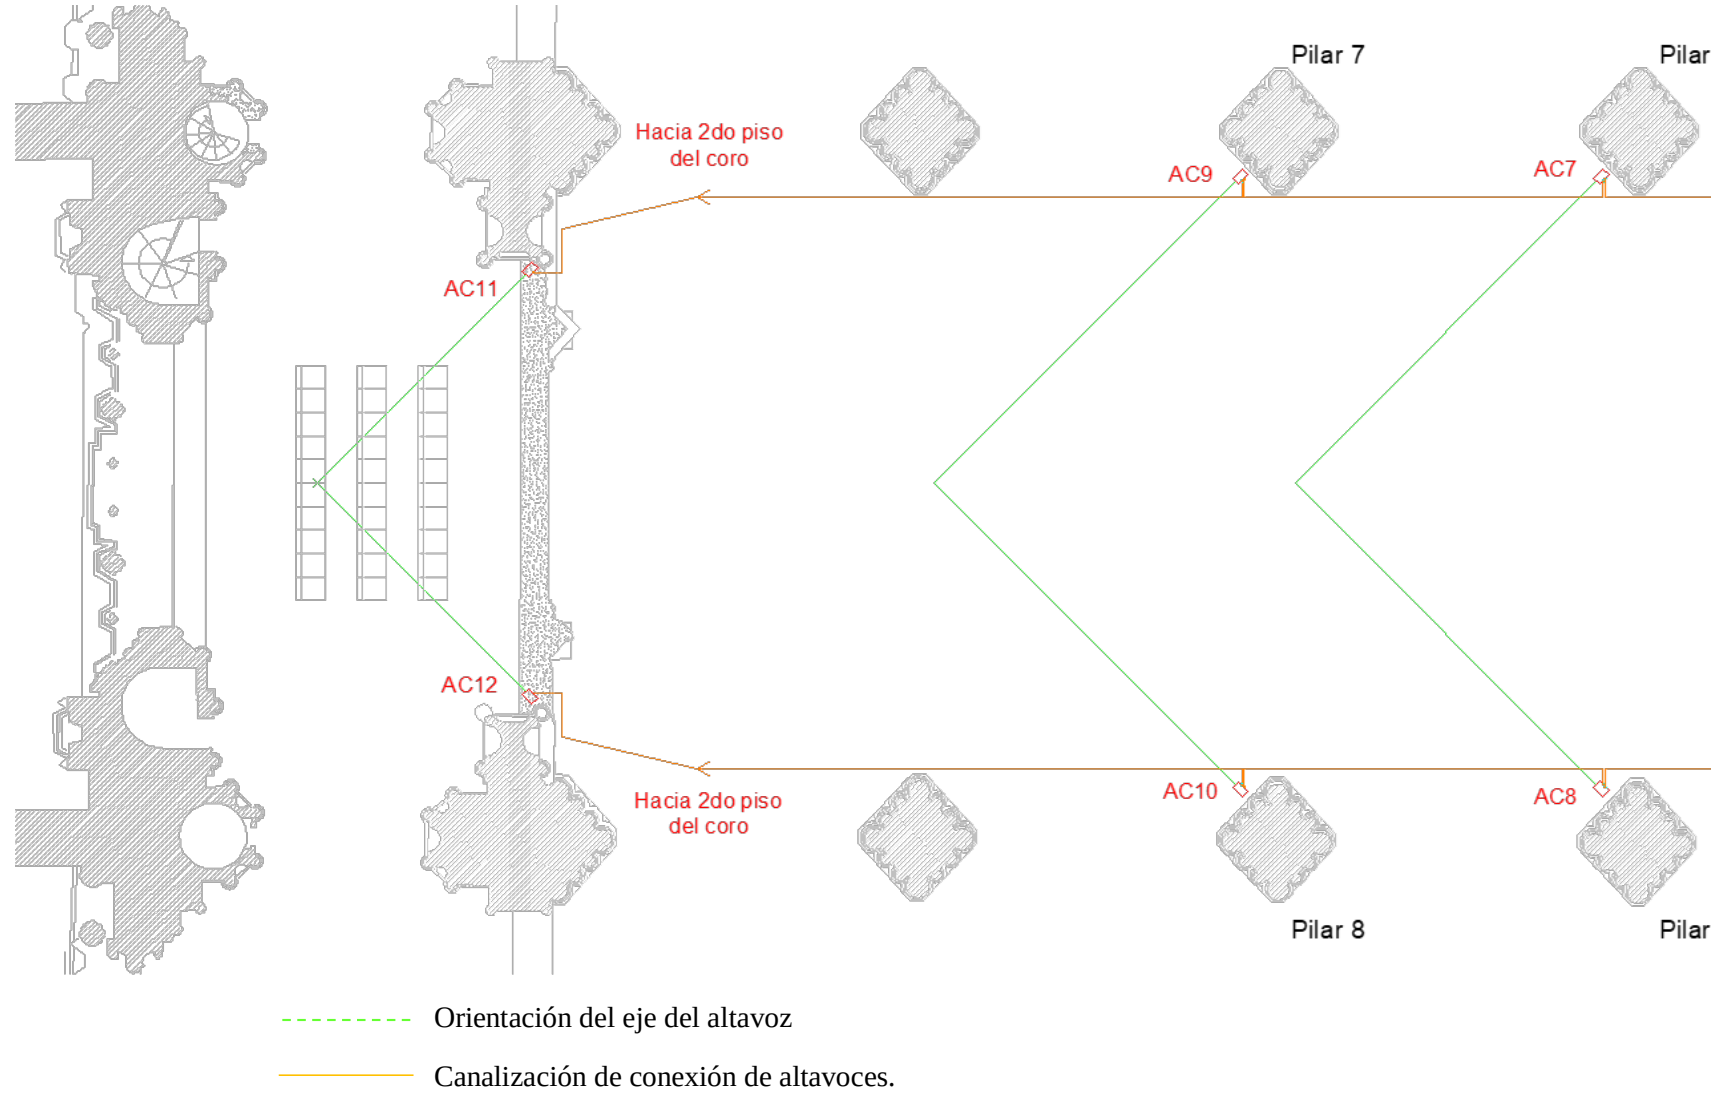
Distribución de los altavoces columnas (AC11 y AC12) en la planta del 2do piso área del coro.
